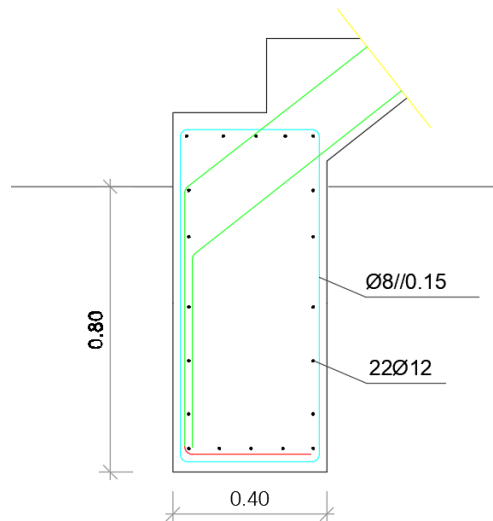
Pormenor de Arranque de Escada Assente no Terreno (Projeto de estruturas).
